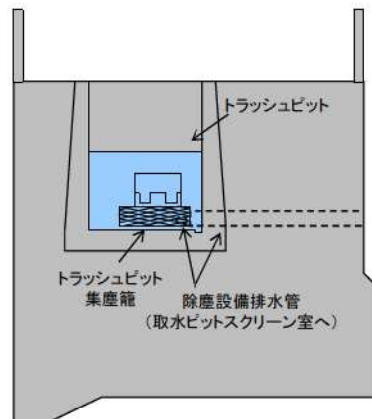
1号及び2号炉取水系統 流入対策配置図 (A-A 断面図)
